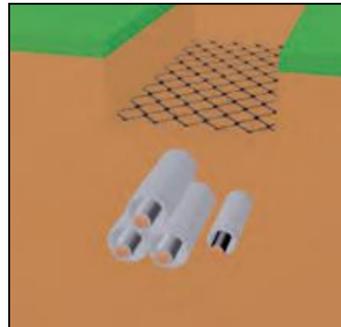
Principe d'enfouissement et coupe d'un câble de raccordement souterrain (source : RTE)
